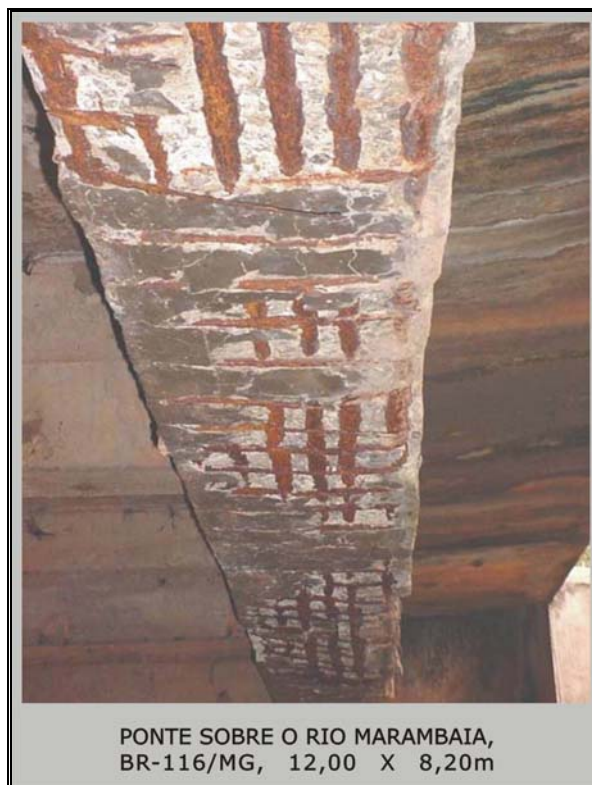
Viga com deslocamento do concreto, ausência de cobrimento, armadura exposta e corroída
